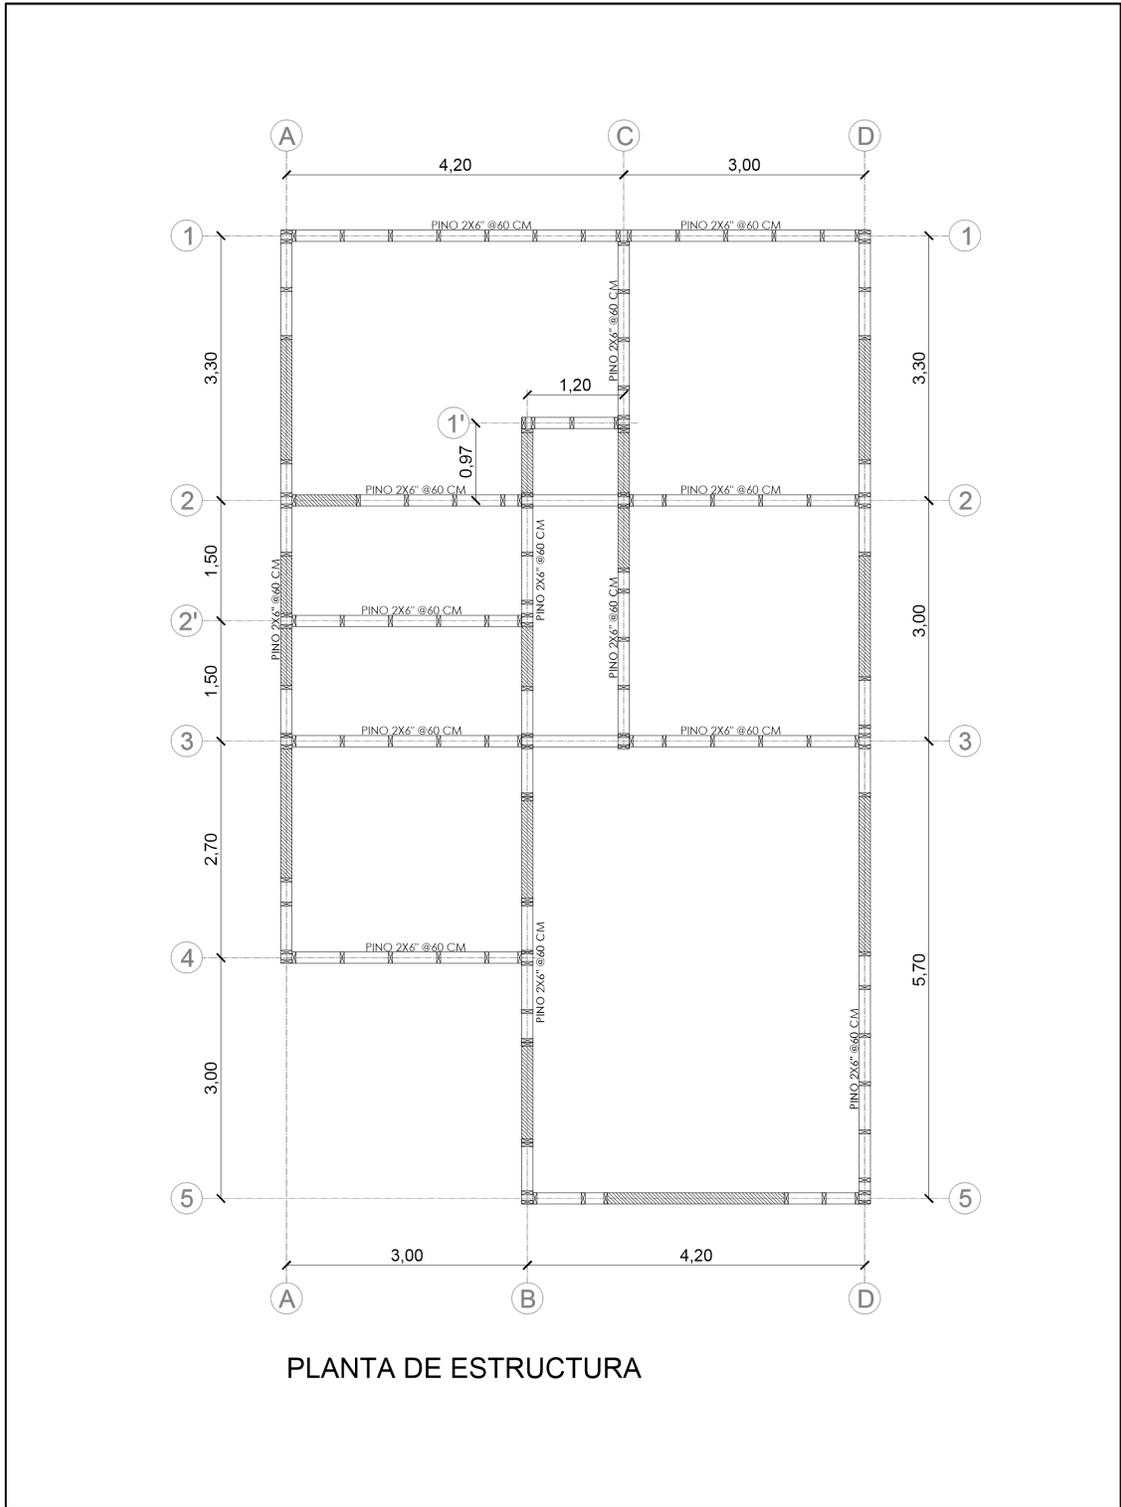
Planta de estructuras modelo entramado de madera 2x6"
